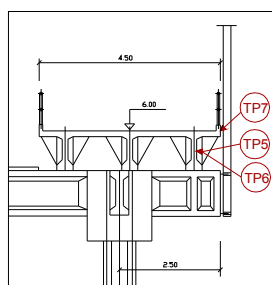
Corte do viaduto do Terminal de Petroleiros (alçado da viga Vt2) – Localização das amostras retiradas da viga VL2 e da laje (TP5, TP6 e TP7).
